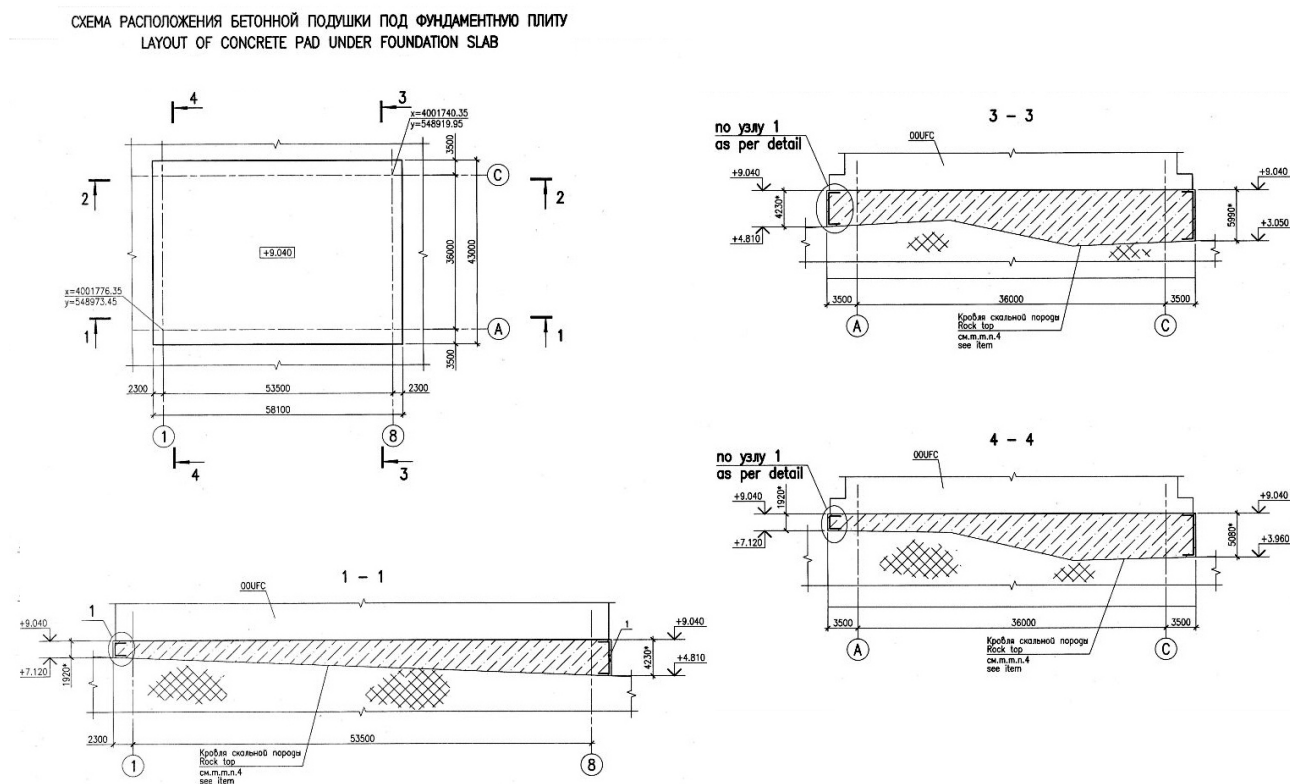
Пример устройства бетонной подушки под фундаментную плиту
